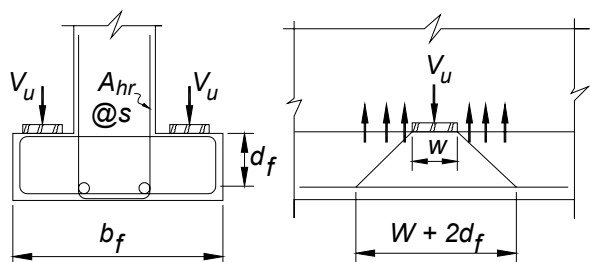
Armadura de suspensión en una viga Te invertida
